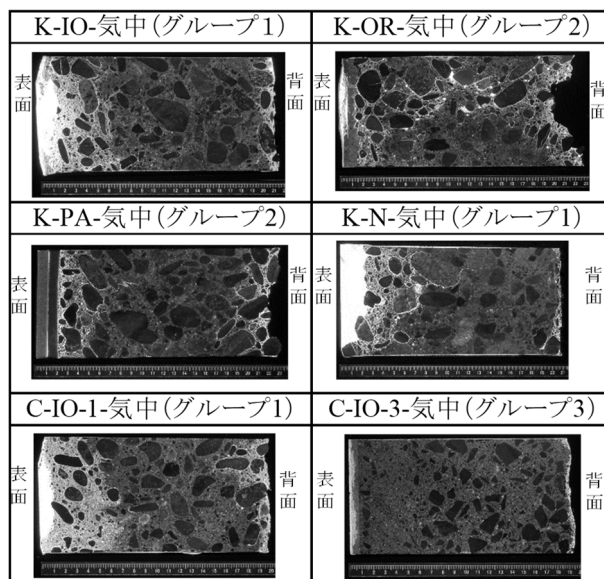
凍結融解試験終了後の微細ひび割れの発生状況
